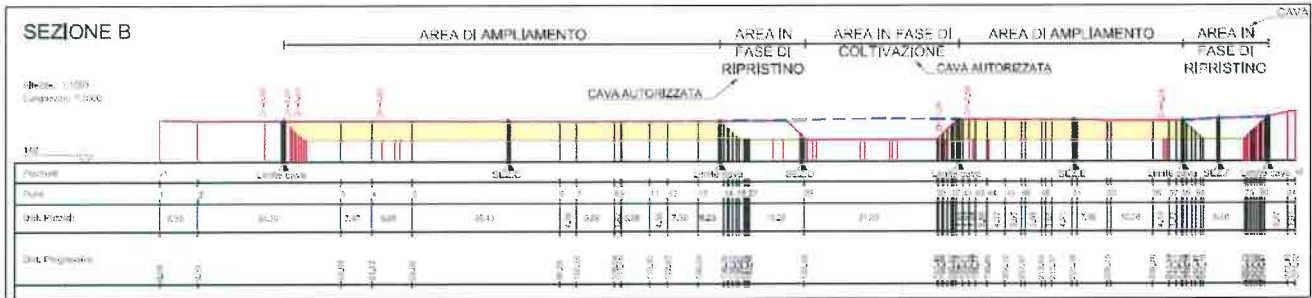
Sezione di scavo con progetto già autorizzato e ampliamento (dalla Tav. A allegata allo SPA)
